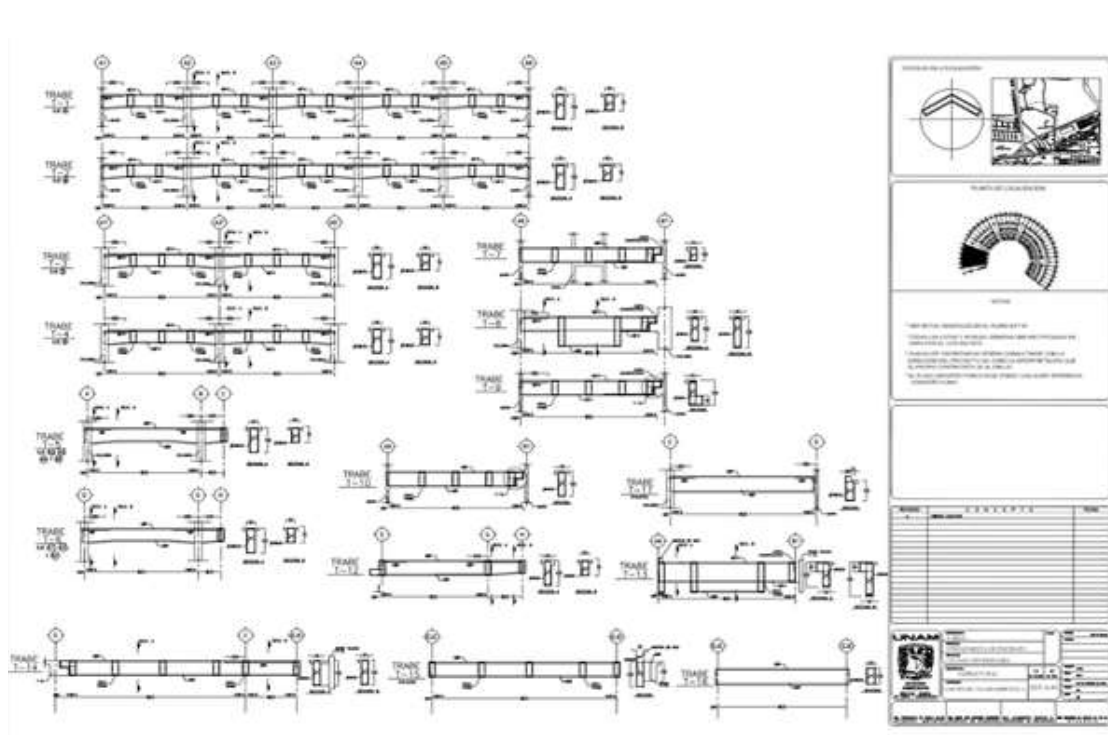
Detalles Armado de Traveses. Planos Estructurales. Unidad de Posgrados UNAM. [Ilustración]. Fuente: Dirección General de Obras y Conservación UNAM.
